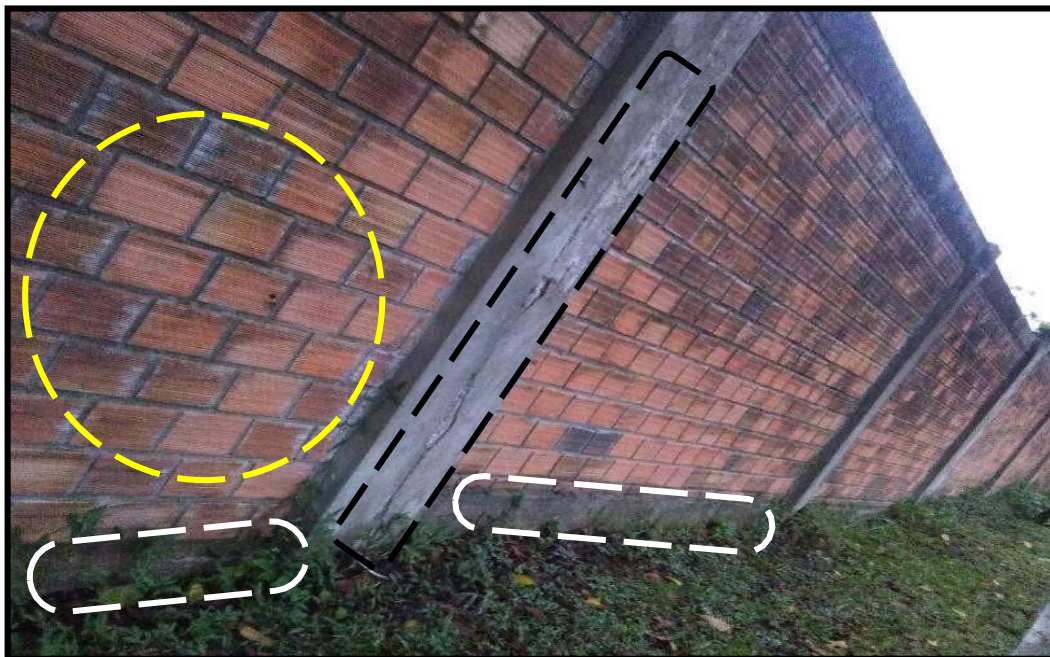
Eflorescencia, agrietamiento vertical y humedad.
